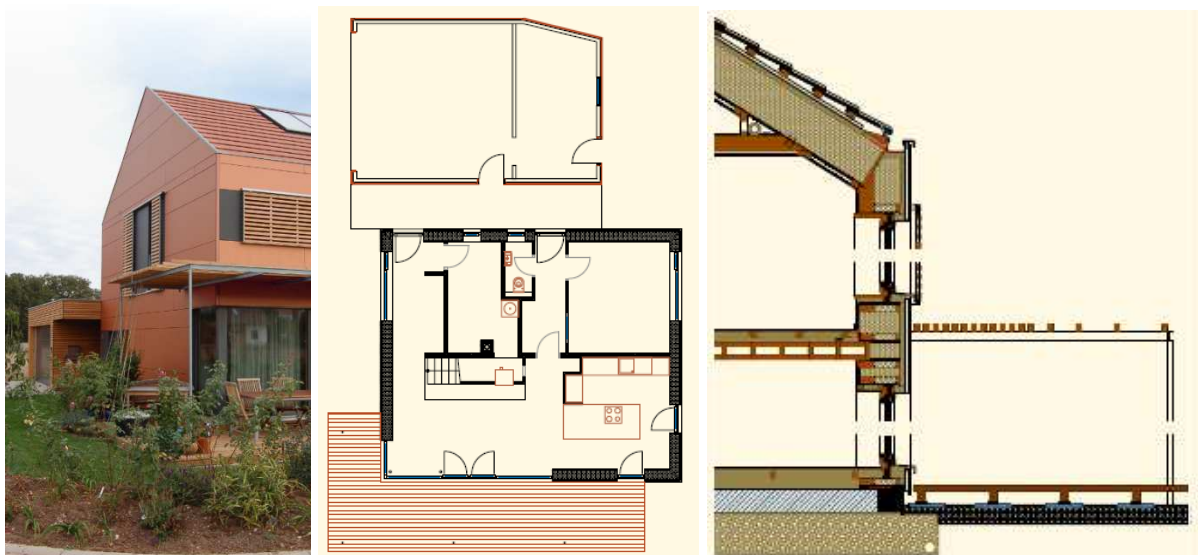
Beispielgebäude: Ansicht, Grundriss EG, Schnitt
